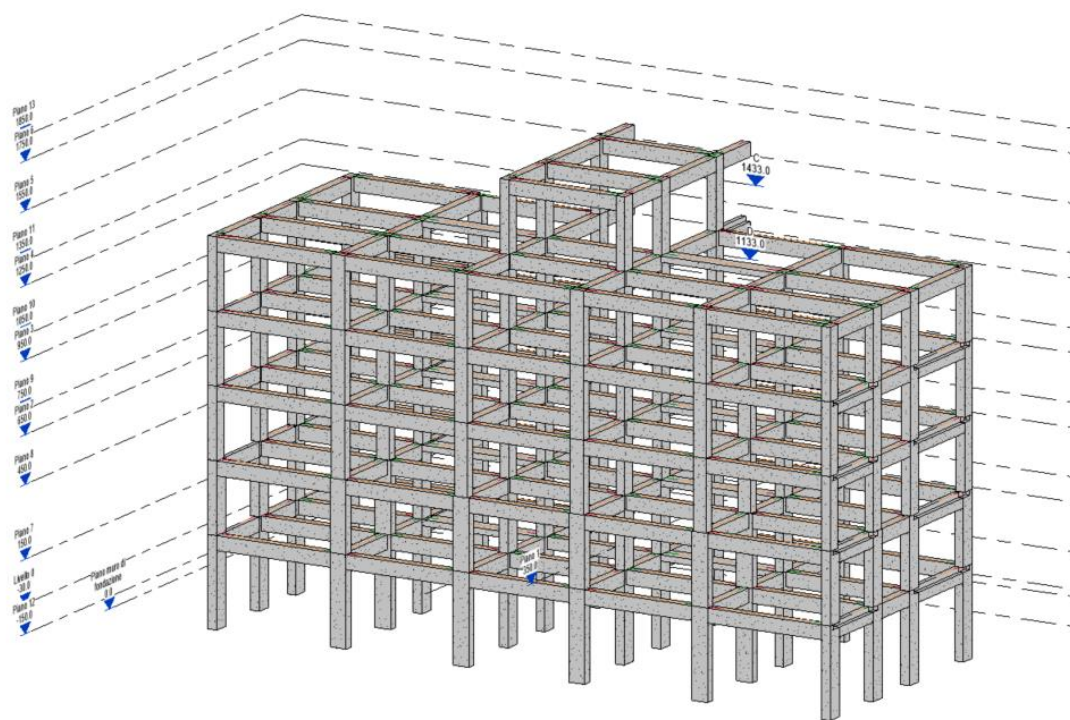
Vista assonometrica della struttura a telaio dell’edificio.
